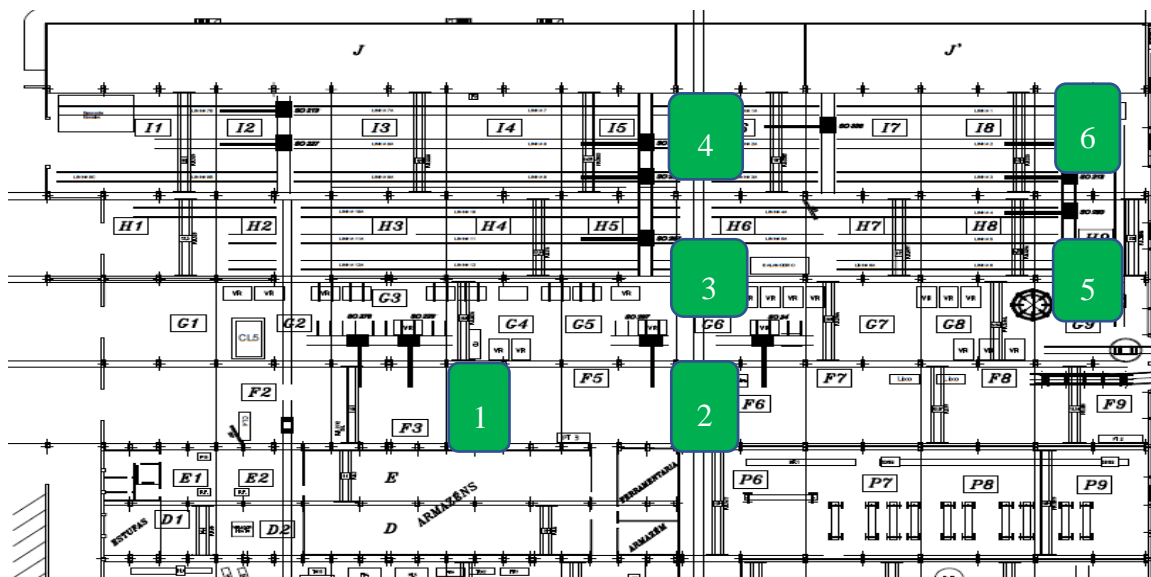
Layout* da fábrica com posição dos postos de alimentação dos cristos de soldadura
